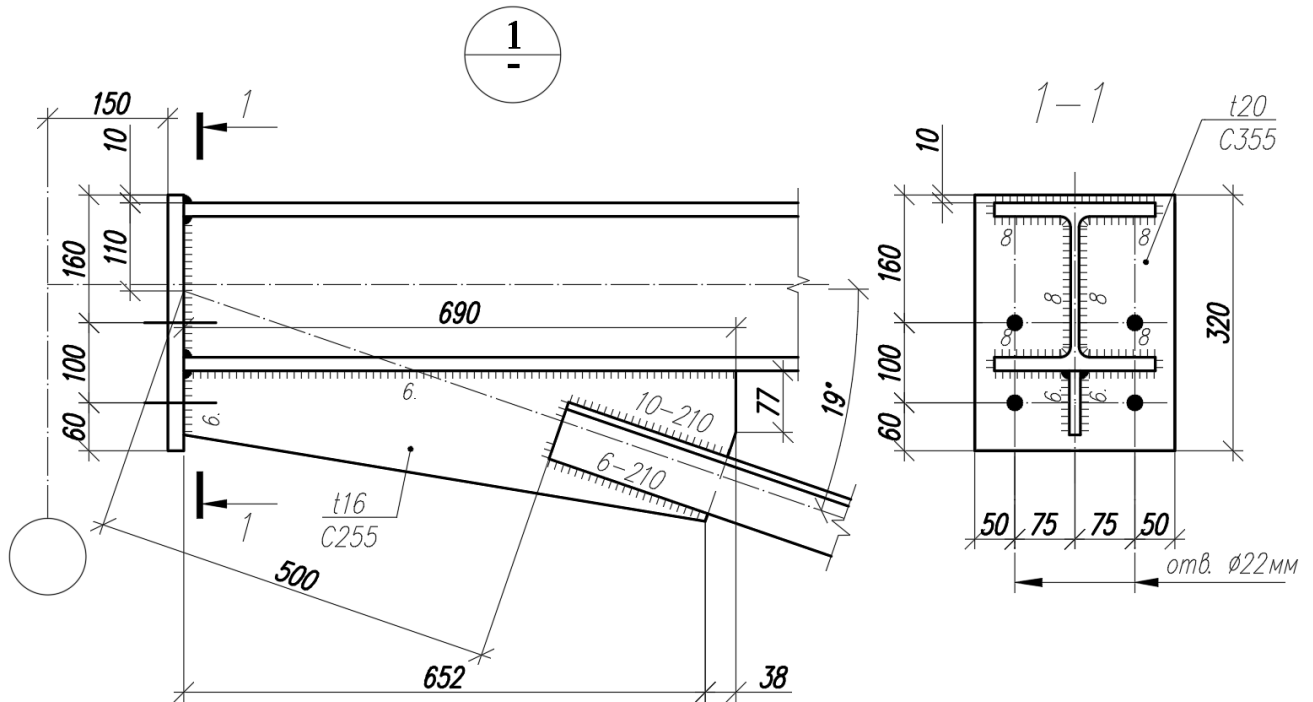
Узел 1 подстропильной фермы ФП-12-52.
